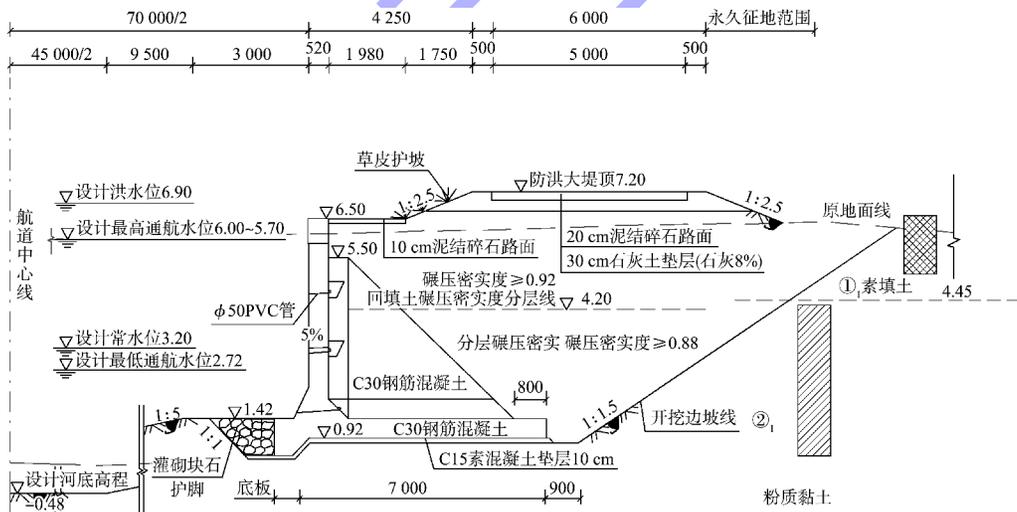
钢筋混凝土扶壁式结构断面 (高程: m; 尺寸: mm)
